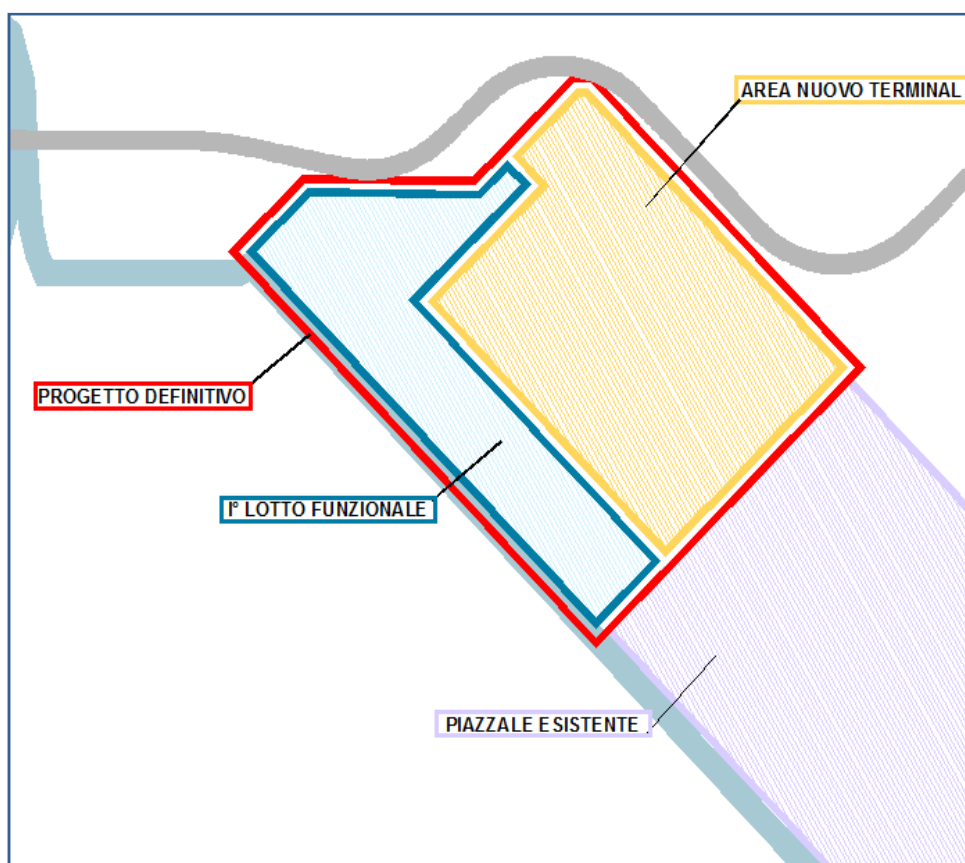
Schema del Progetto Generale e del I° Lotto Funzionale.
